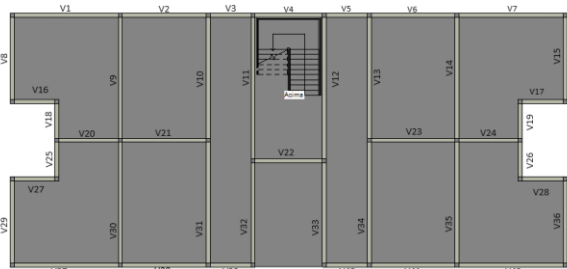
Planta baixa alocação das vigas. Fonte: Autora 2024
